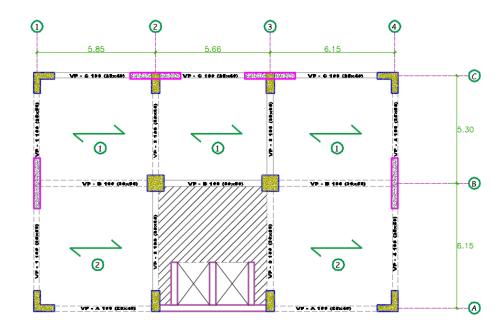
Plano estructural del 2° al 12° piso de la alternativa 02
